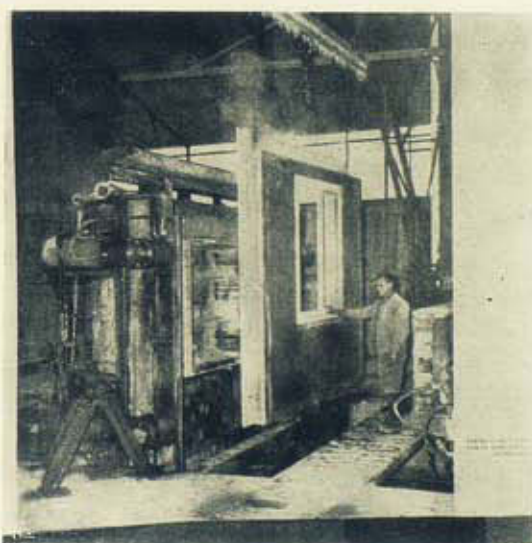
Elevação final do elemento de fachada — ver ainda vapor de água.
